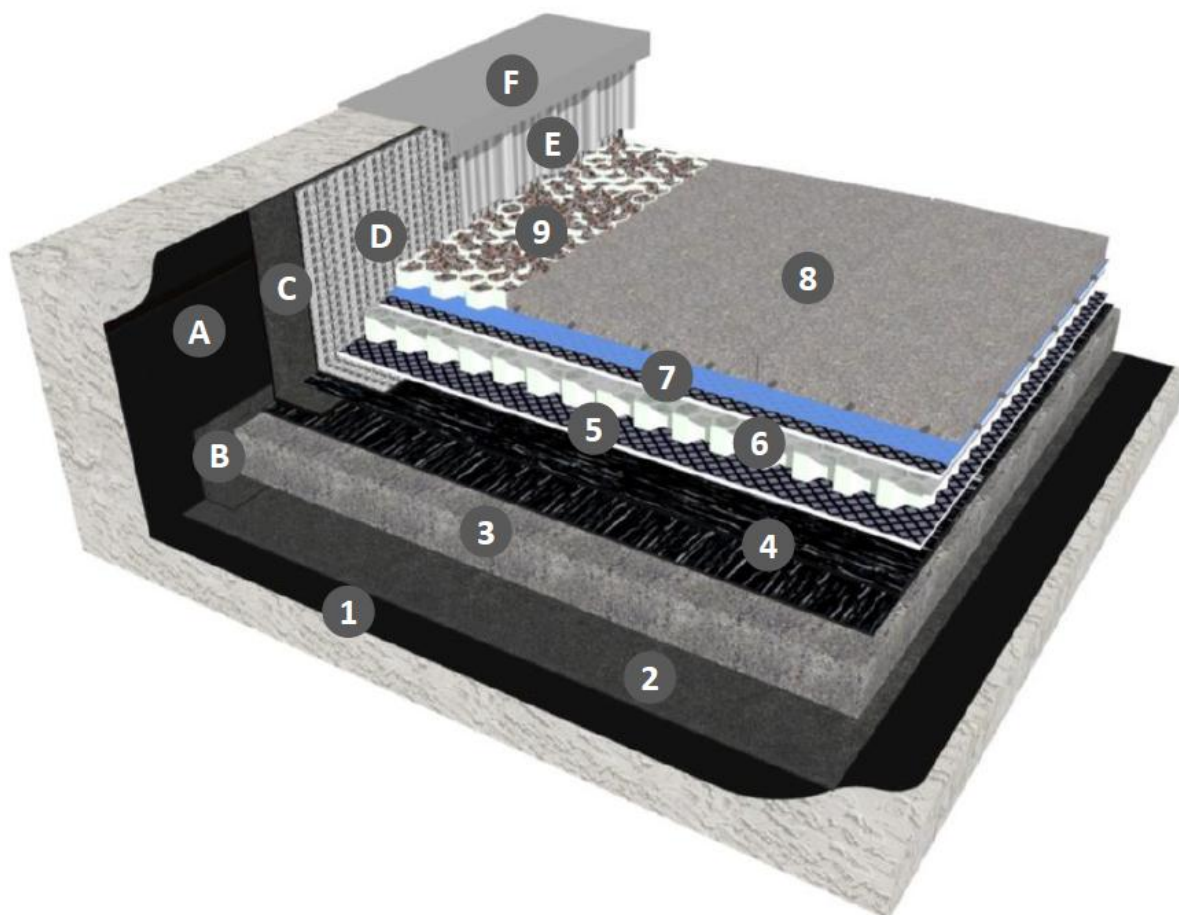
Toiture terrasse accessible aux piétons avec protection par pavés ou dalles selon NF P 98-33
